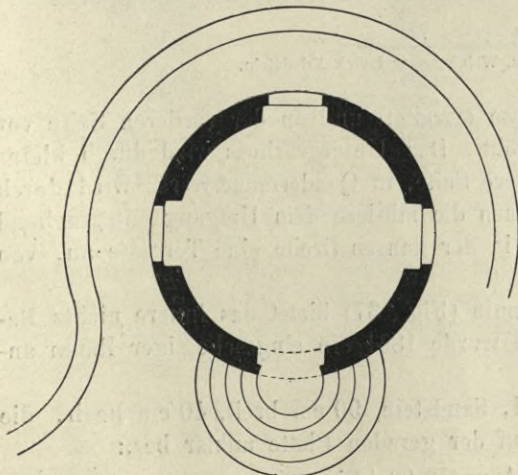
Niederlössnitz, Grundriss des Jakobsthurmes.
